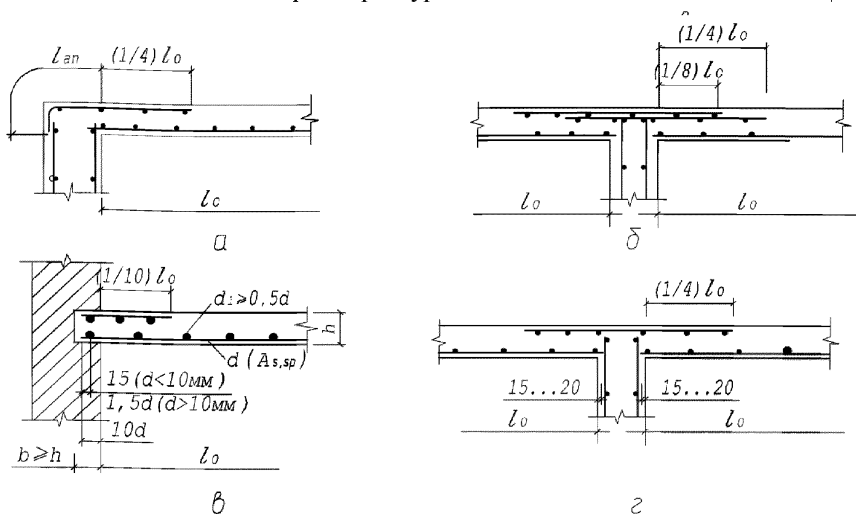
Армирование опор плит сварными сетками:
